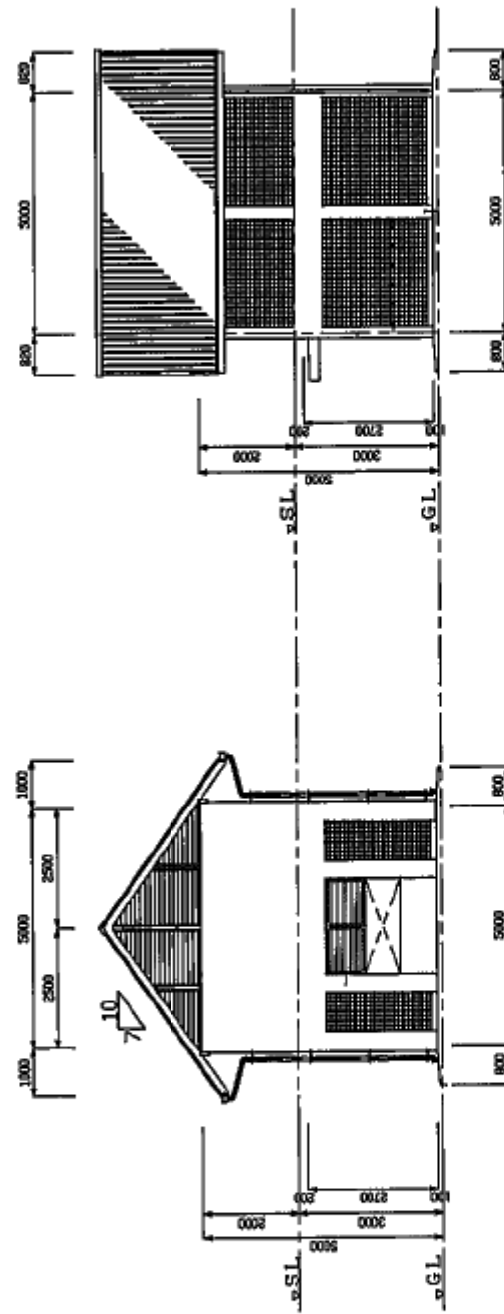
10 製氷機・貯氷庫棟平面・断面図
